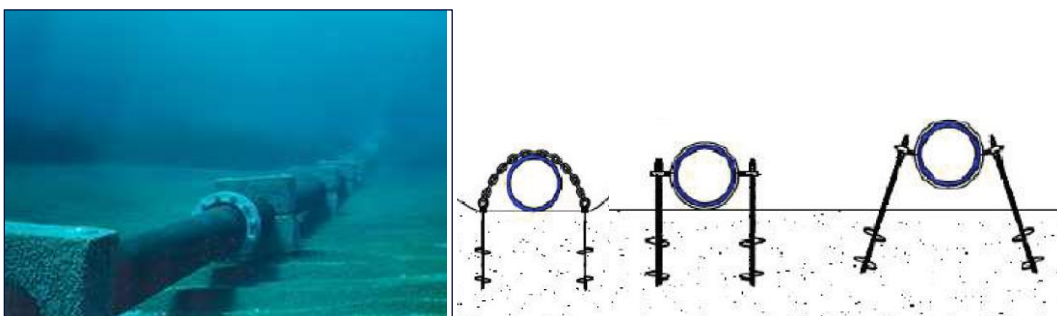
Exemples de conduites A) lestées avec des cavaliers béton, B) fixée par ancre à vis
